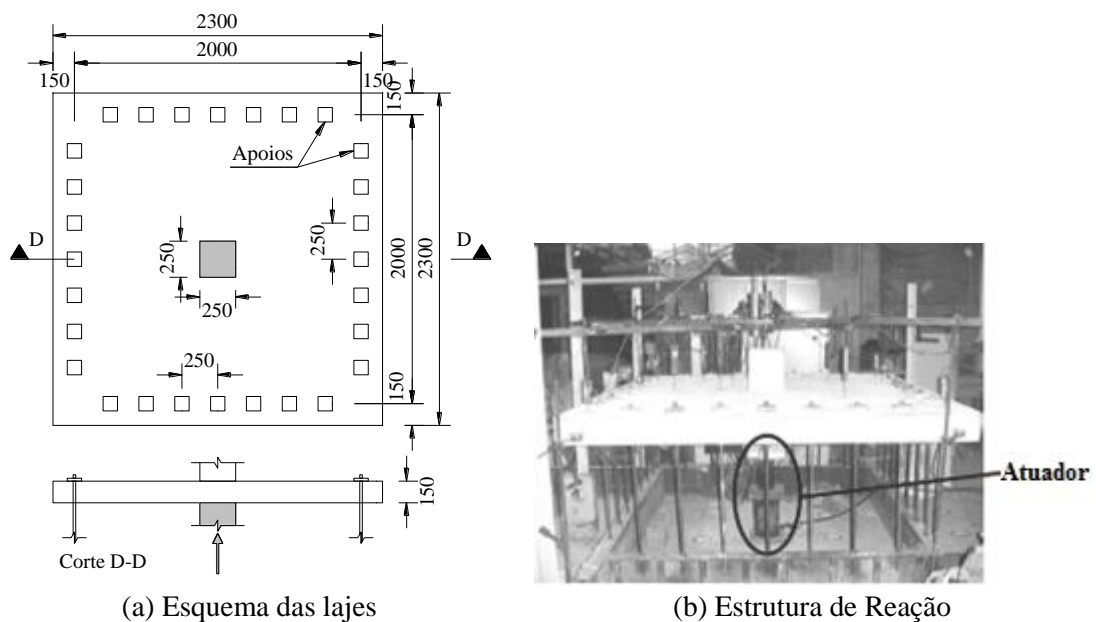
Sistema de ensaio - Estrutura de reação (ERDOGAN, 2010)
